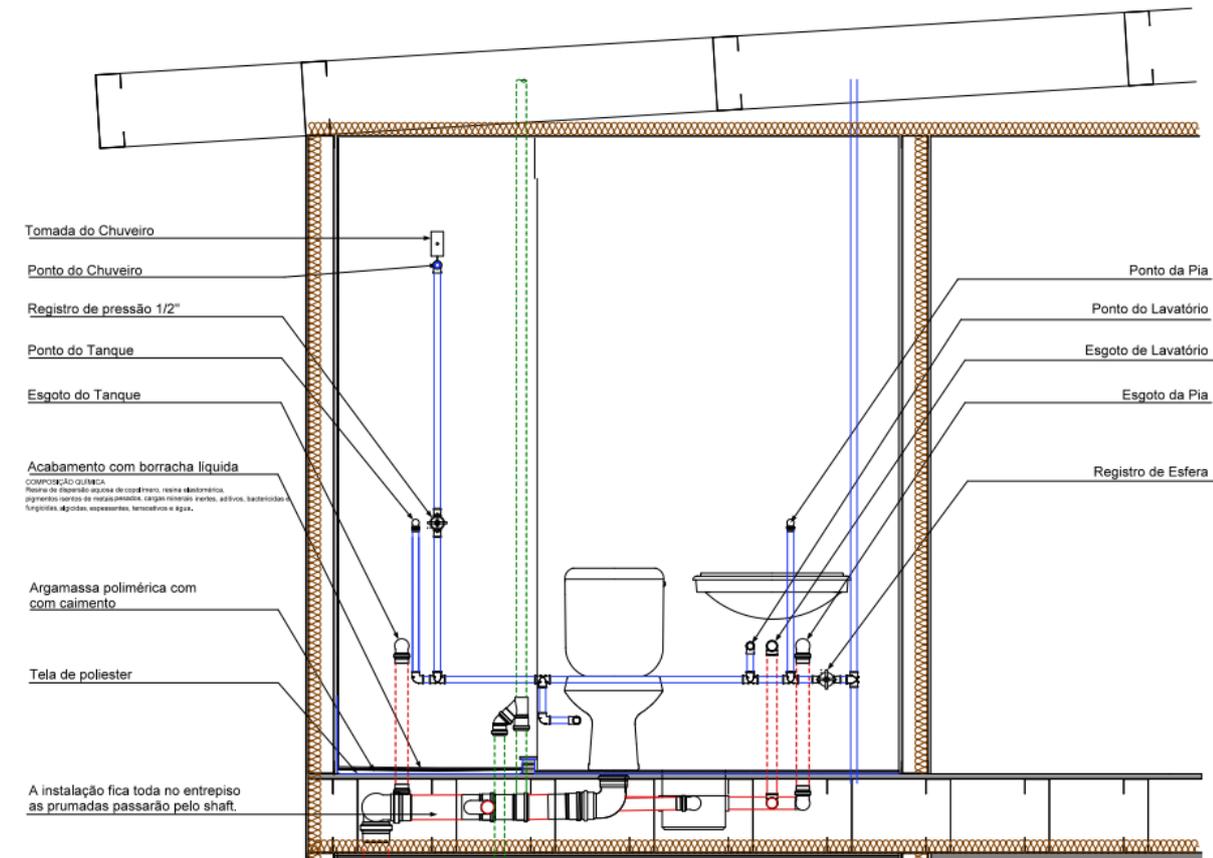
Detalhe da ligação do entrepiso com as paredes
